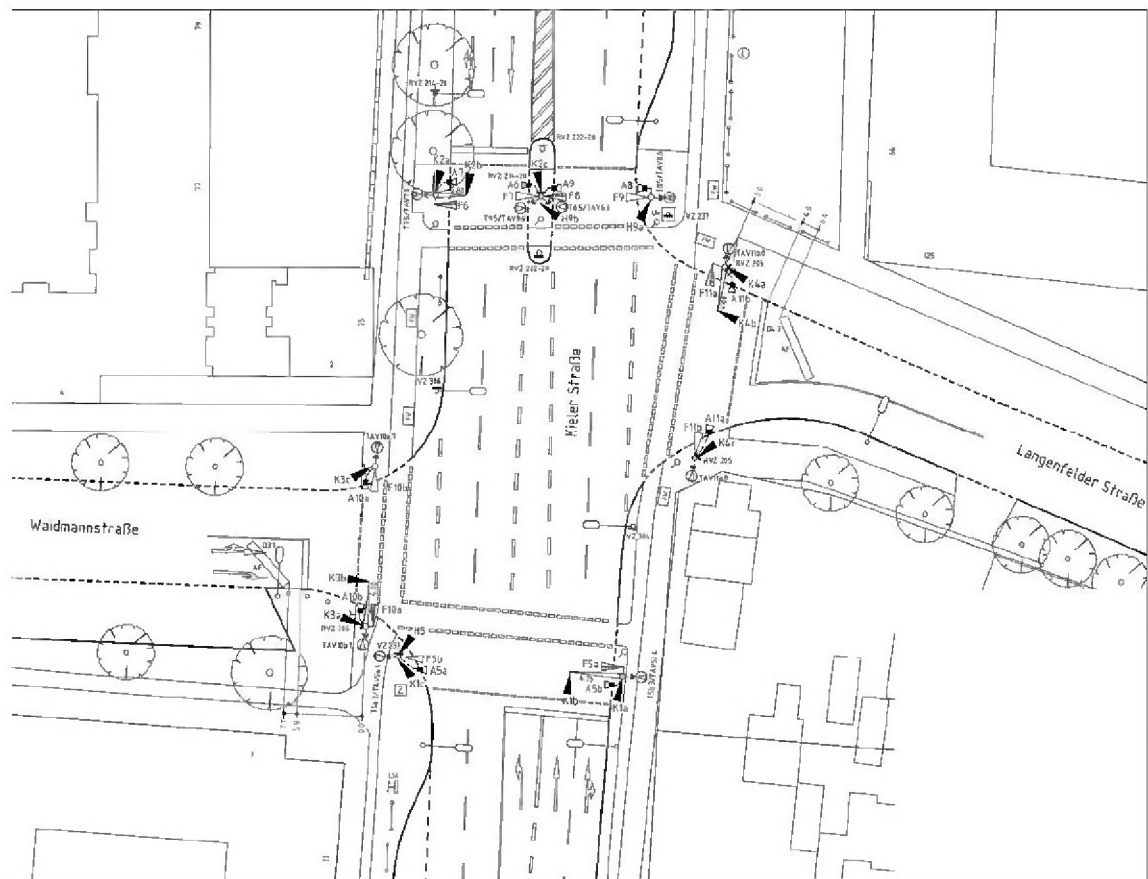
Signallageplan Kieler Straße/Waidmannstraße – Bestand (17/1332-04-05/00)
